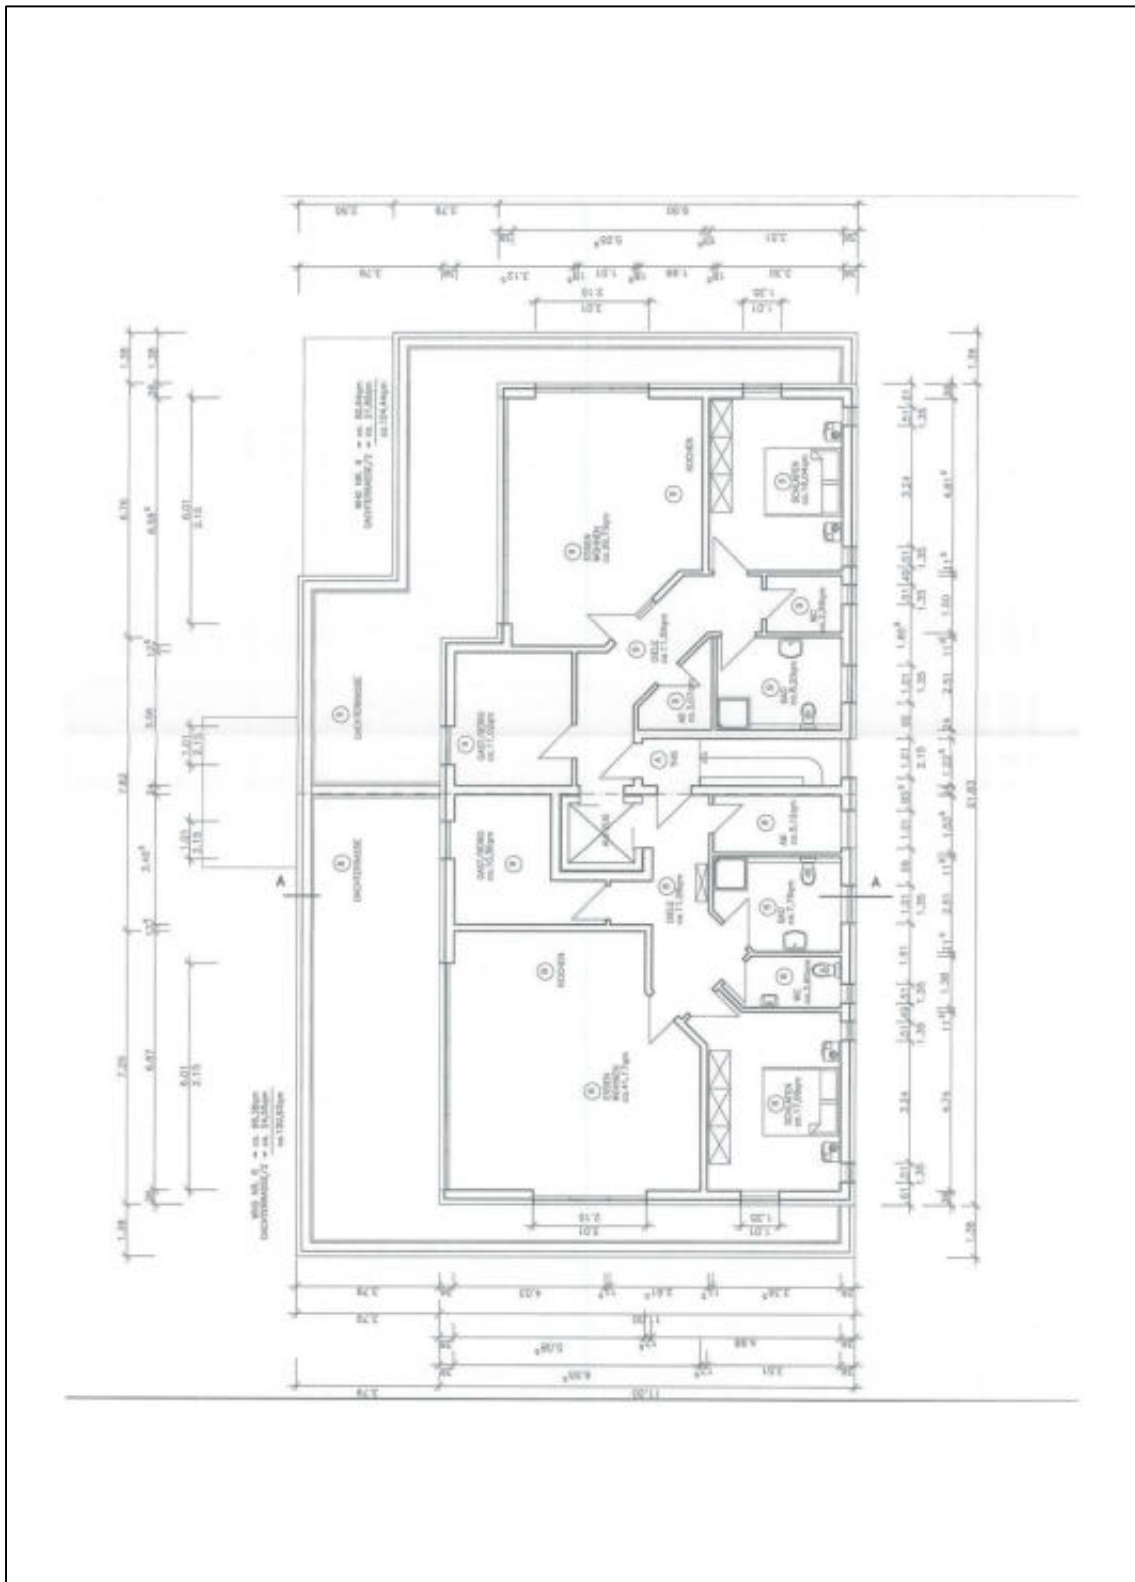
Grundriss vom Staffelgeschoss
